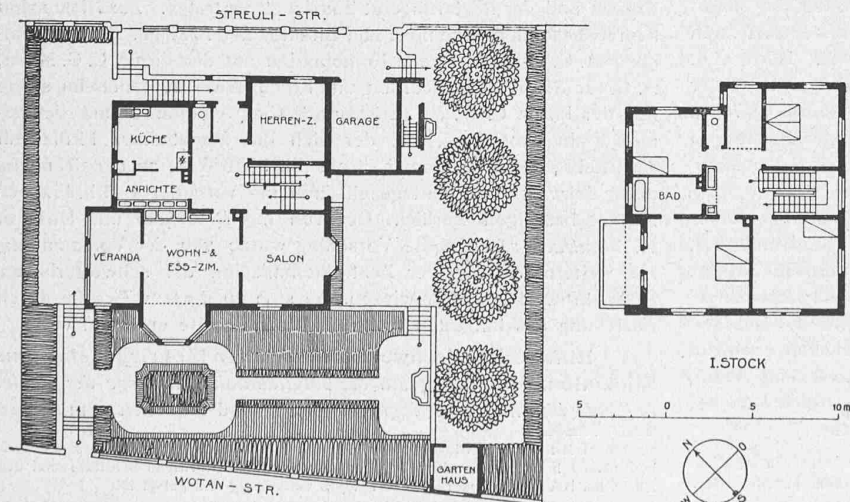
und 24. Einfamilienhaus Streulistrasse 54. — Grundrisse 1:400.
